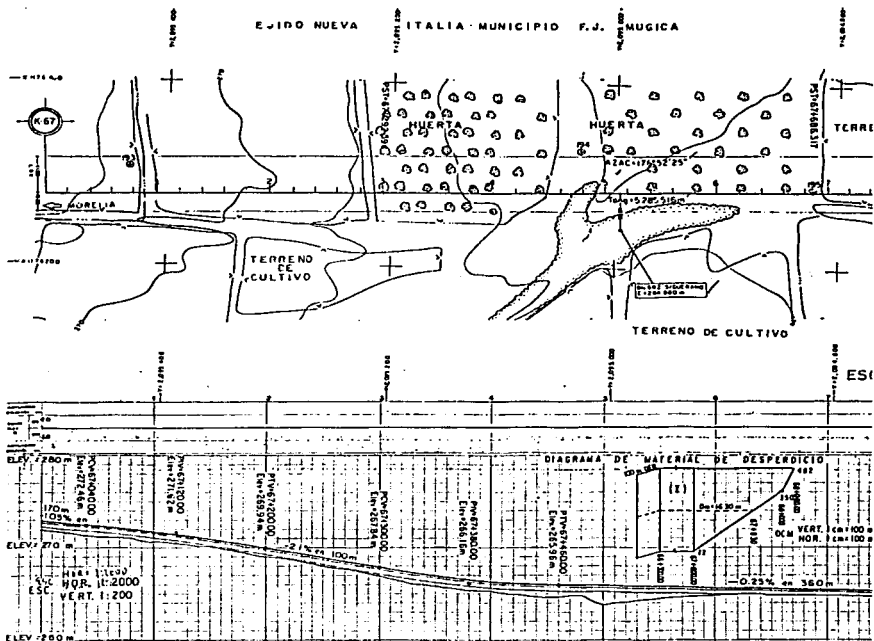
Planta y perfil del km. 67+000 al km.67+780
